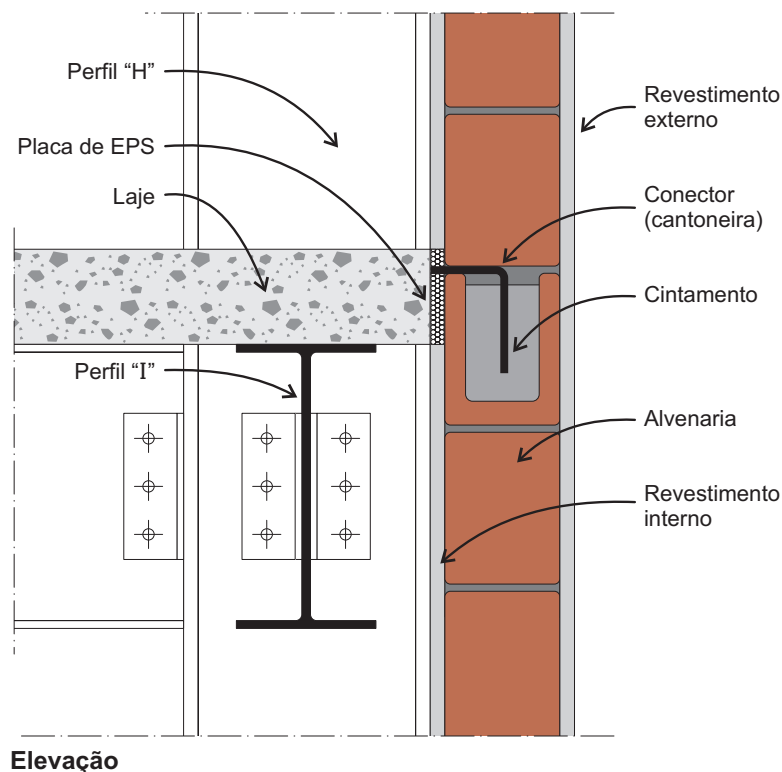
Alvenarias posicionadas externamente à estrutura metálica.
